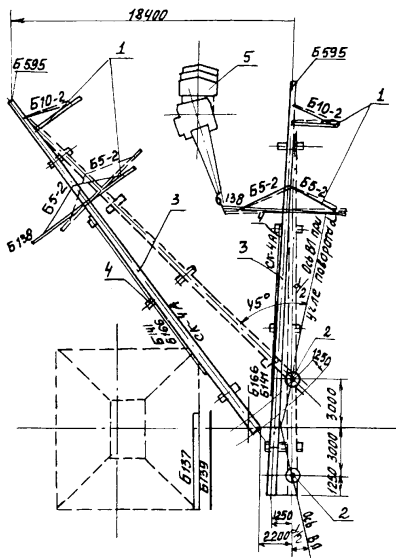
Схема выкладки и сборки опор УБ 220-1; 4Б220-5.
